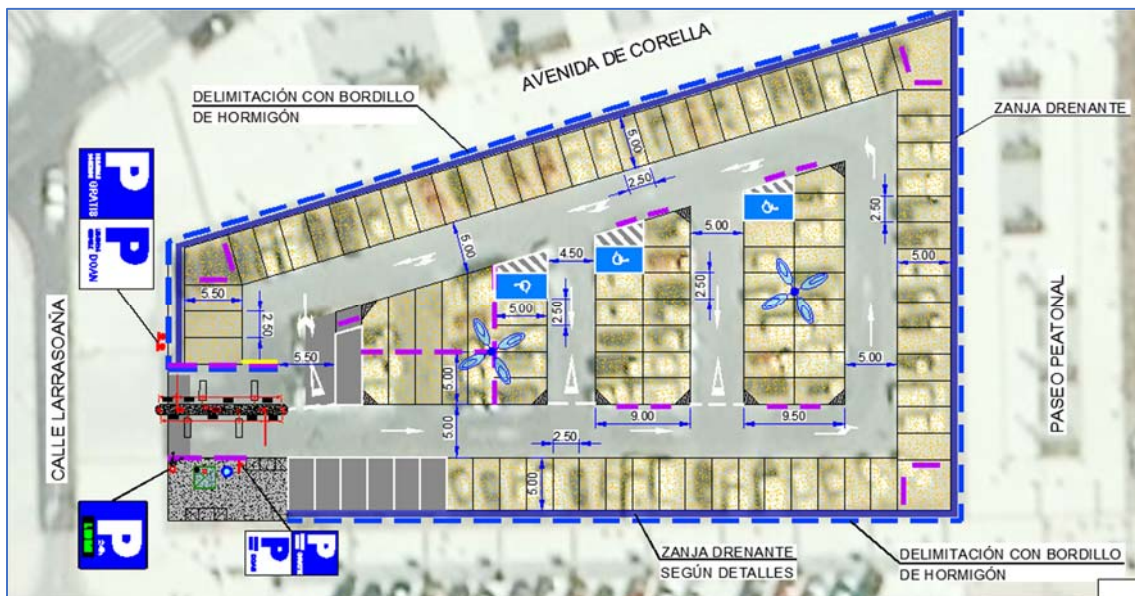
Detalle del plano de planta del estado definitivo del aparcamiento de Ezcaba..
